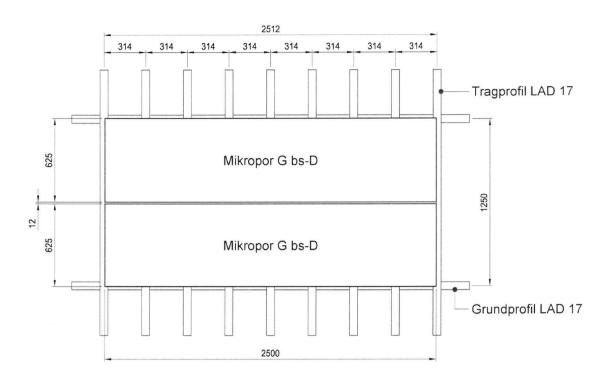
Technische Zeichnung der Musterkonstruktion, Deckenunterseite
